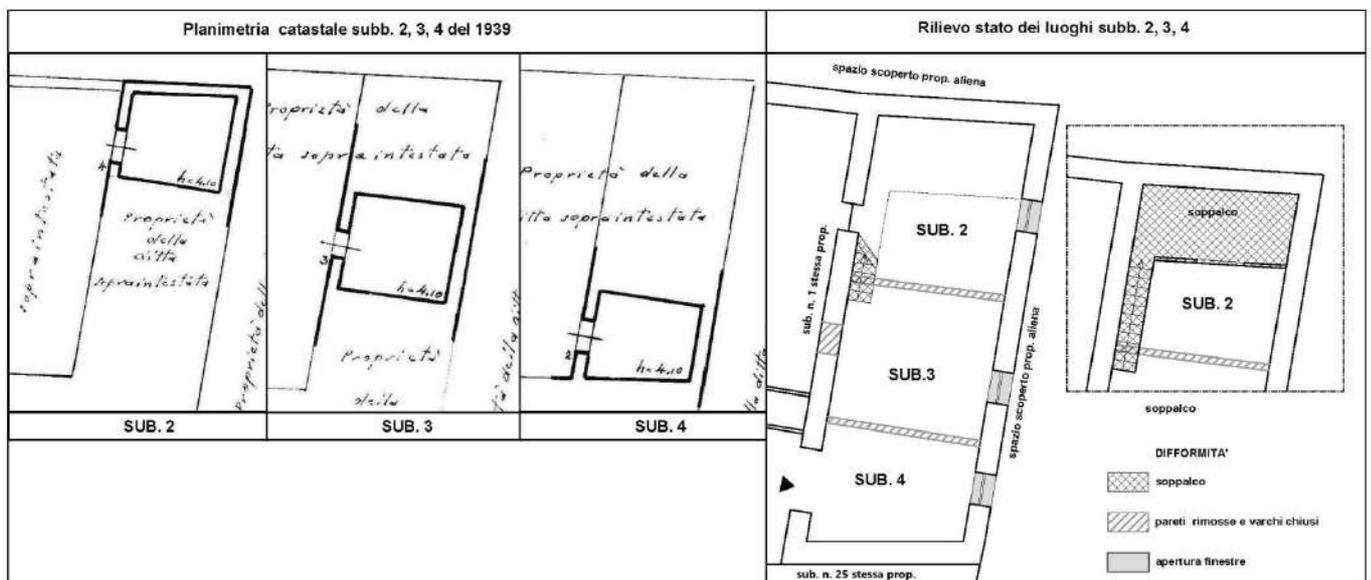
Confronto tra la planimetria catastale dei subb. 2, 3, 4 e il rilievo dello stato dei luoghi. Campita con tratteggio la difformità.
